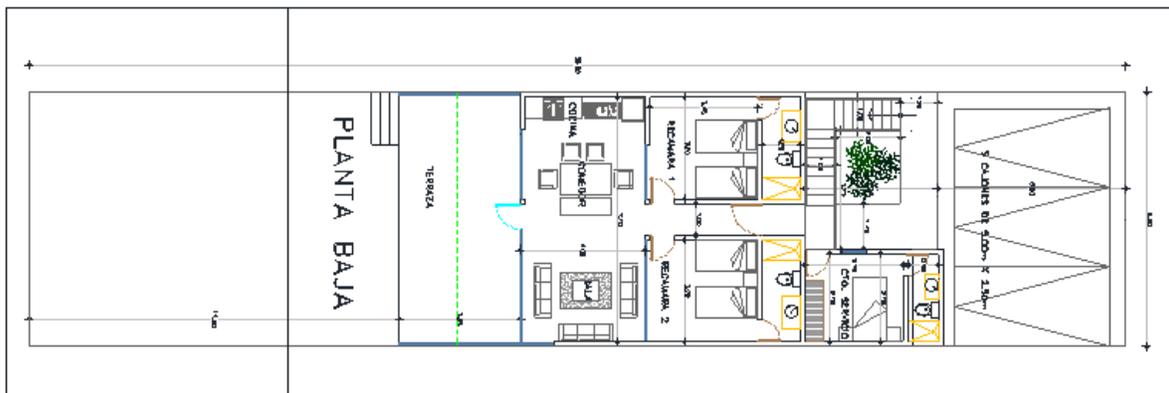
Planta arquitectónica de Casa Celestún. Corte planta baja.
